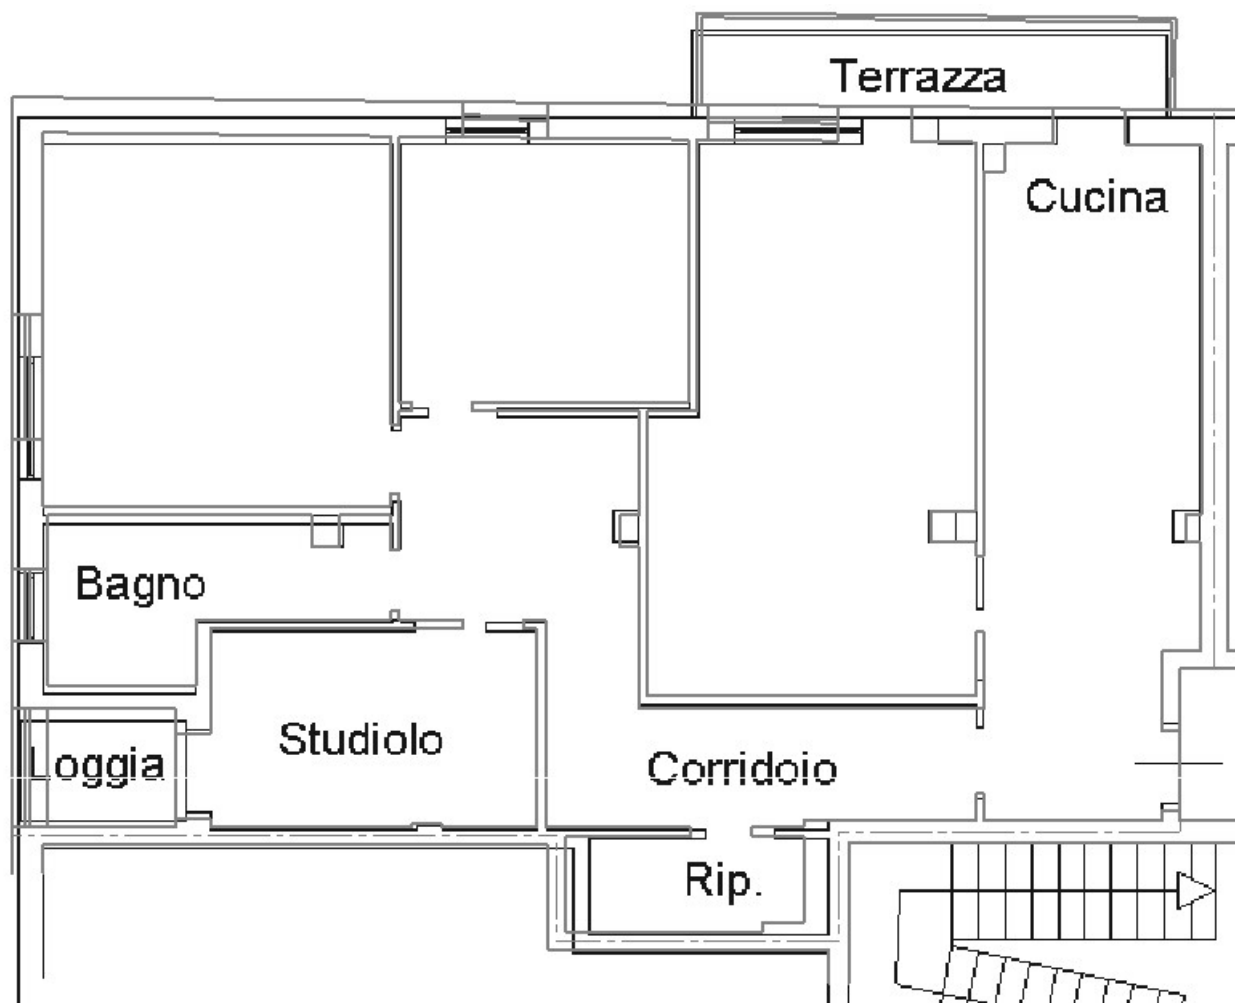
Sovrapposizione tra lo stato reale dei luoghi e la planimetria catastale
